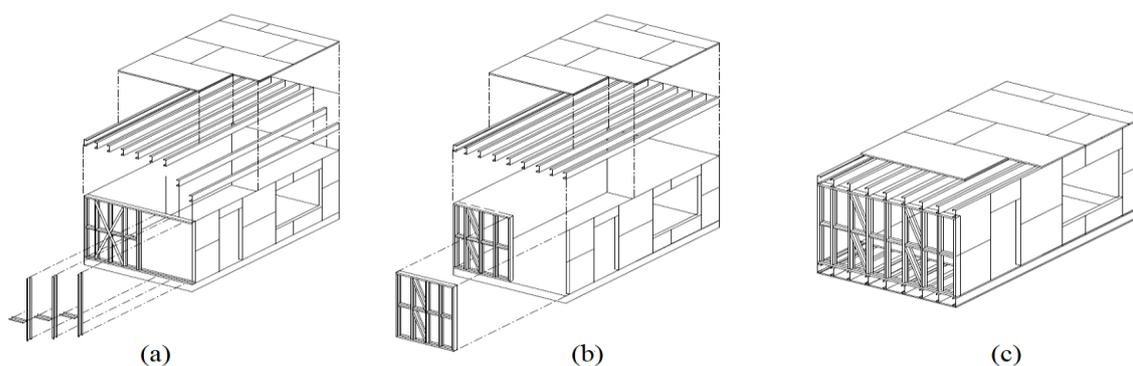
Métodos construtivos em LSF: (a) construção por perfis “*stick-build*”; (b) construção por painéis; (c) construção modular (Grubb *et al.*, 2001)
